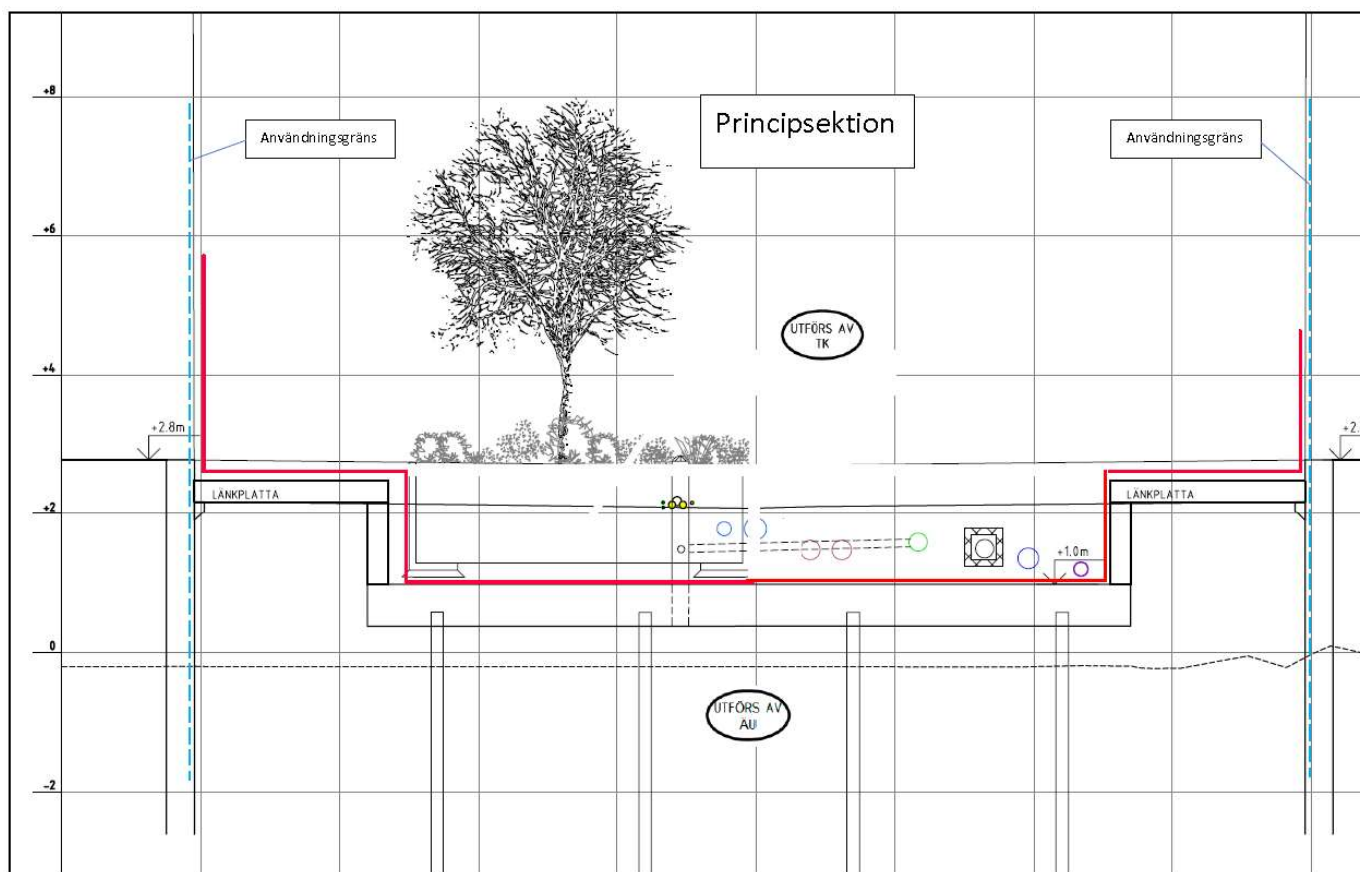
Principiellt gränssnitt för den allmänna platsens indelning i över- och underbyggnad på halvön.
